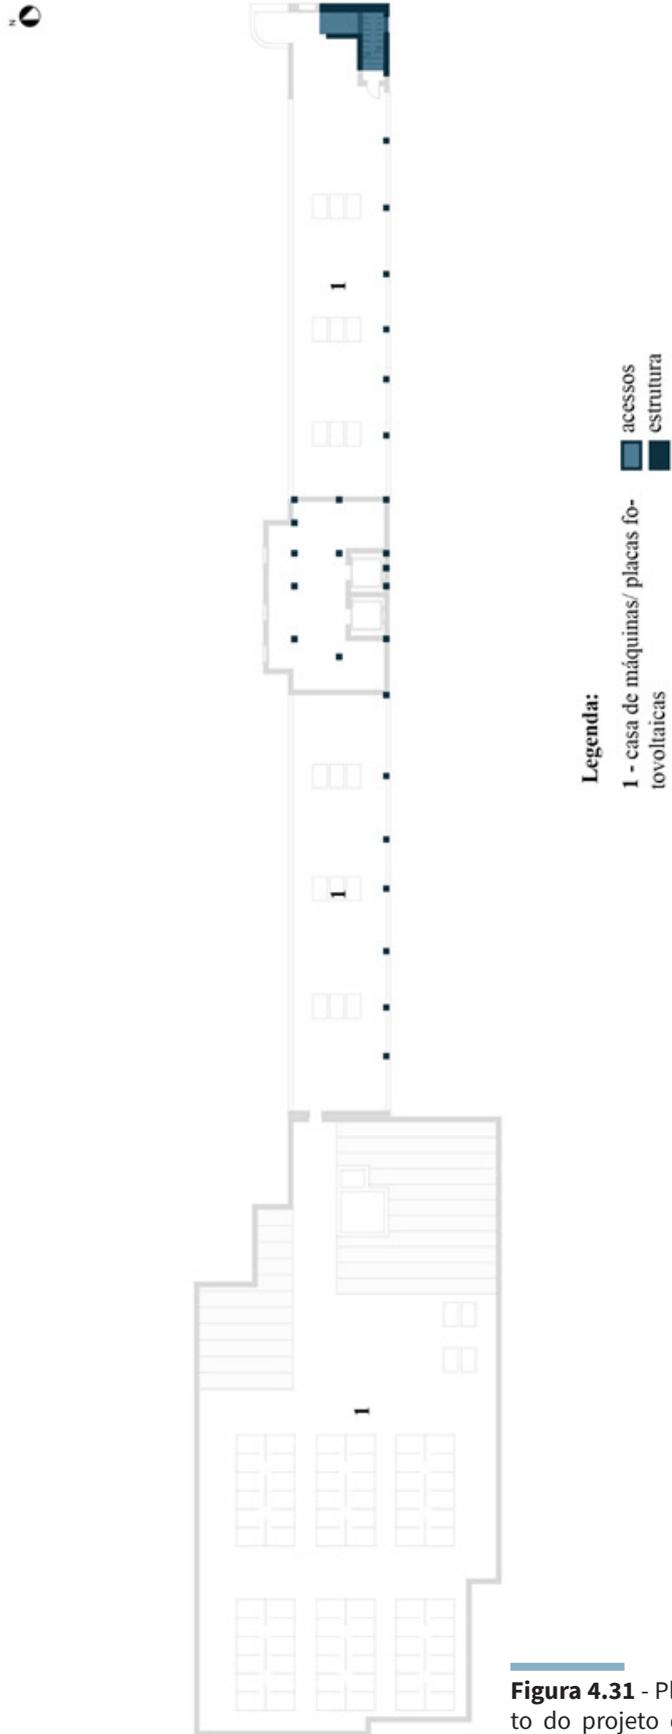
Planta do 8º pavimento do projeto de reforma do Lord Hotel.
